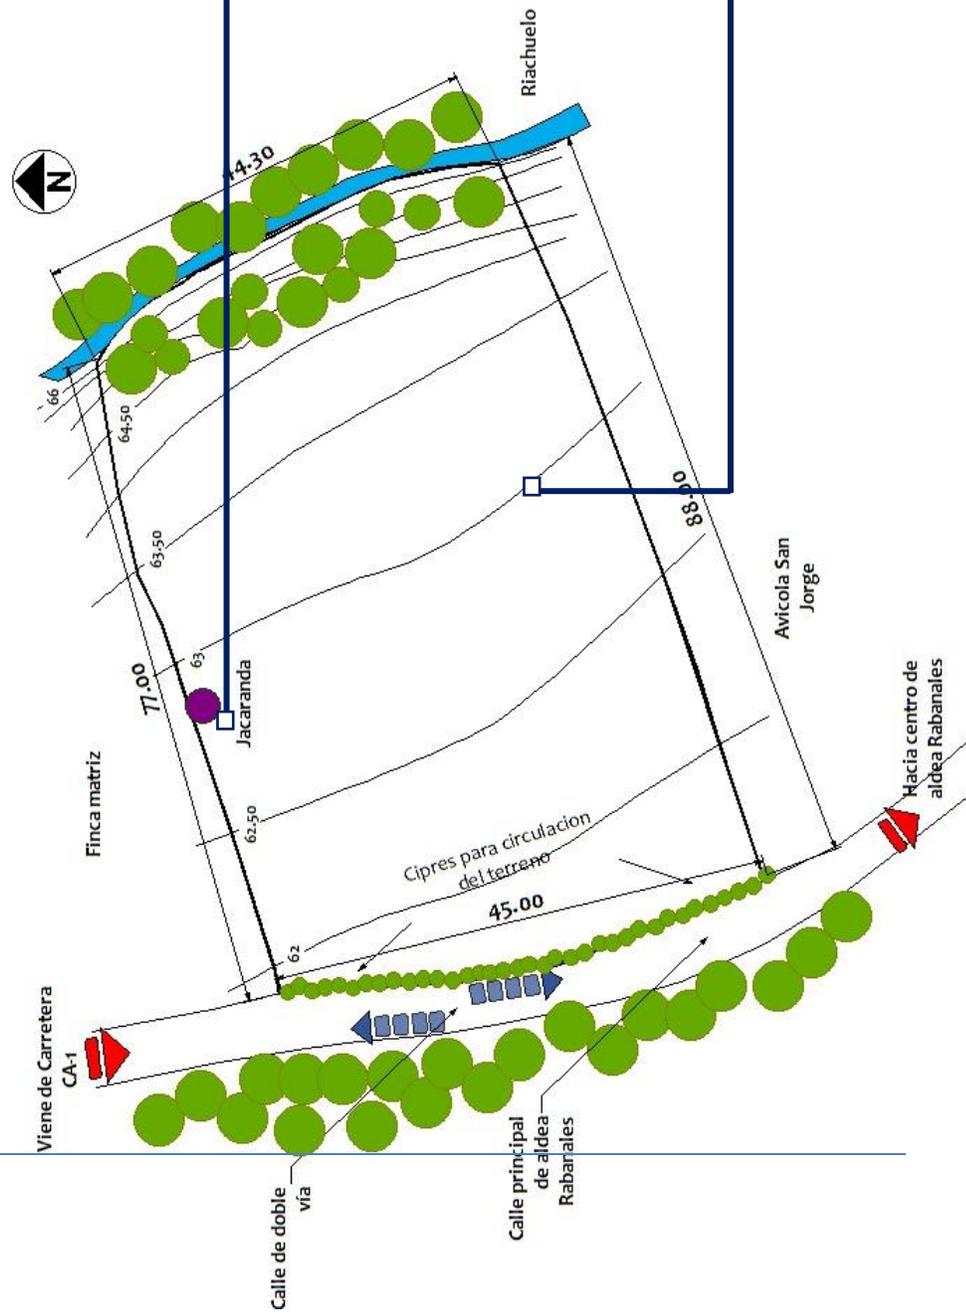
Jacaranda existente dentro del terreno propuesto para anteproyecto.
